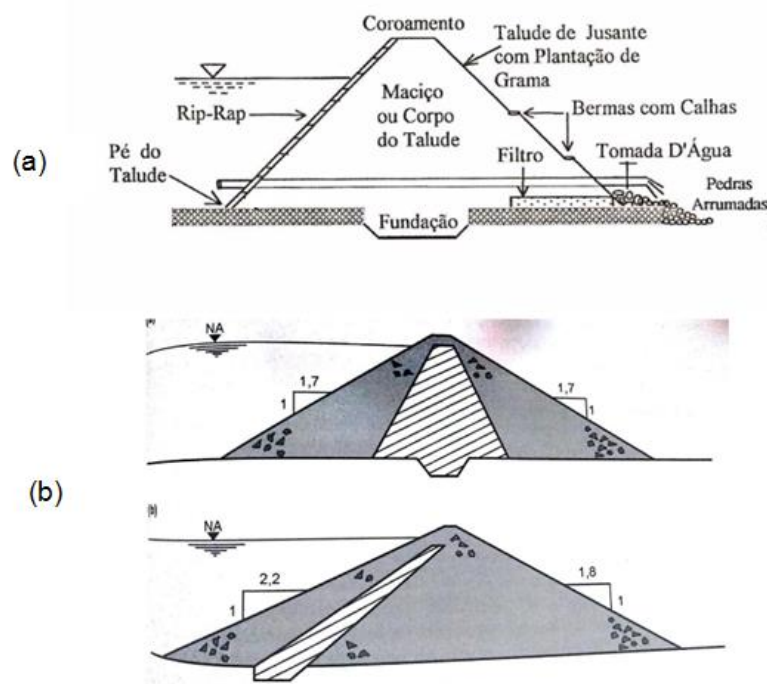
Desenhos esquemáticos dos elementos que constituem uma barragem de terra (a) e de seções transversais de barragens de terra e enrocamento (b).
